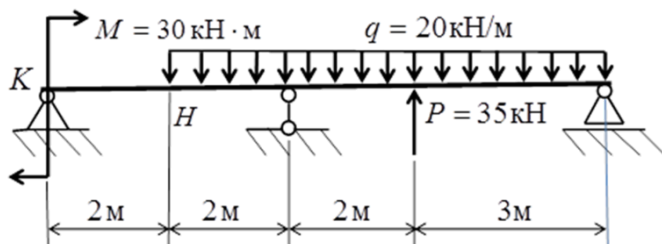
Схема 4 навантажень та закріплення балки
